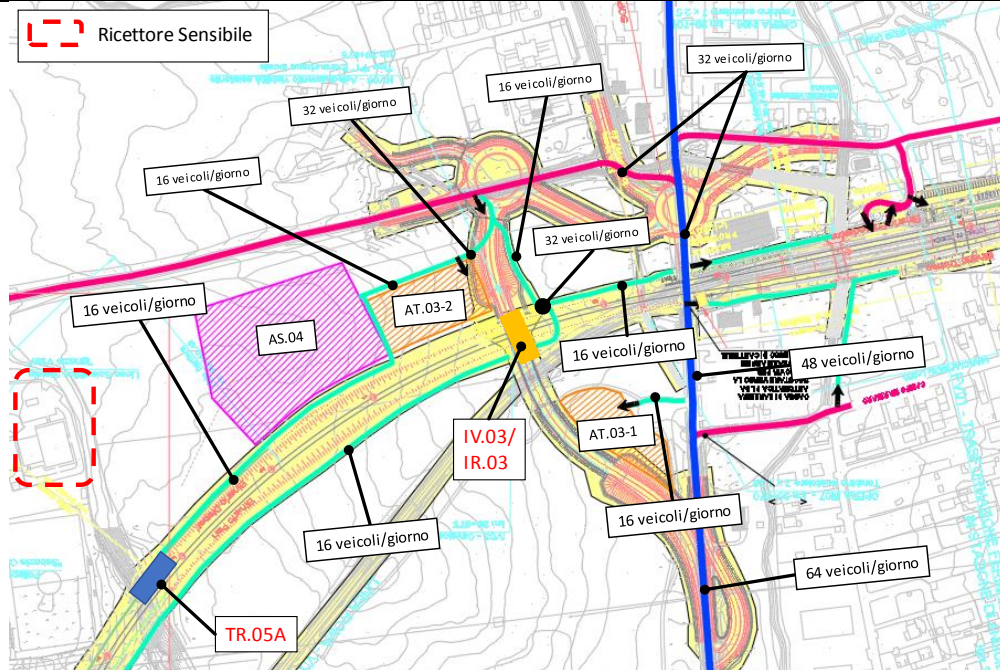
Distribuzione dei traffici di cantiere in planimetria per lo scenario 2
